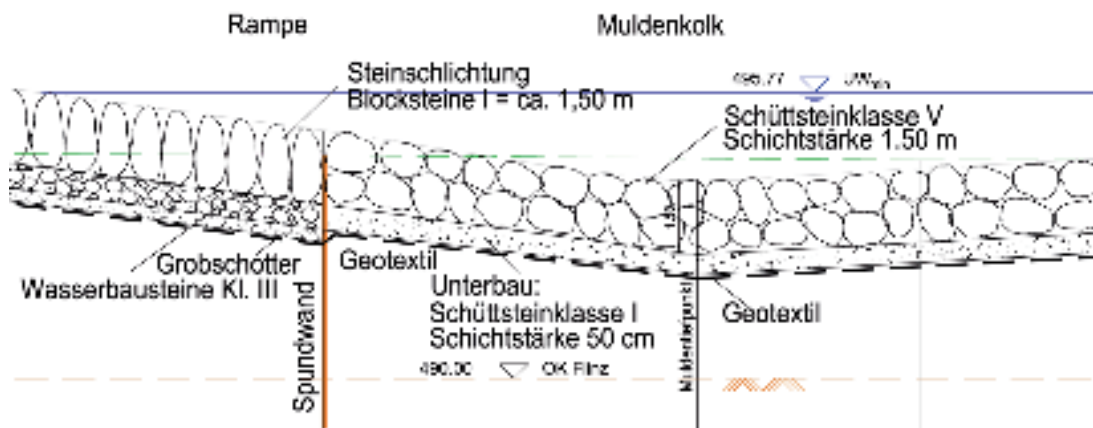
Längsschnitt mit Sohlenaufbau.
